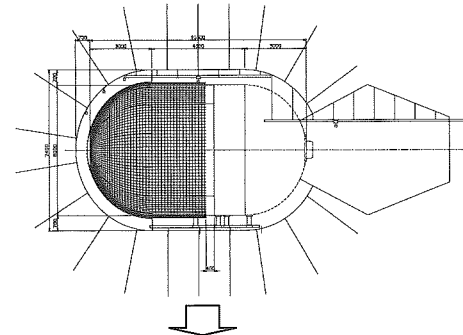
に示すように気密材の施工は、気密材を3段階(①奥側半球部+赤道板2スパン⇒(移動)⇒②赤道板1スパン⇒③プラグ側半球部)に分けて貯槽奥側から施工した。緩衝材の外側にあるひび割れ分散のための鉄筋は、かぶりを50mmとし、緩衝材を吹付けた後、順次、鉄筋を配筋していった。
